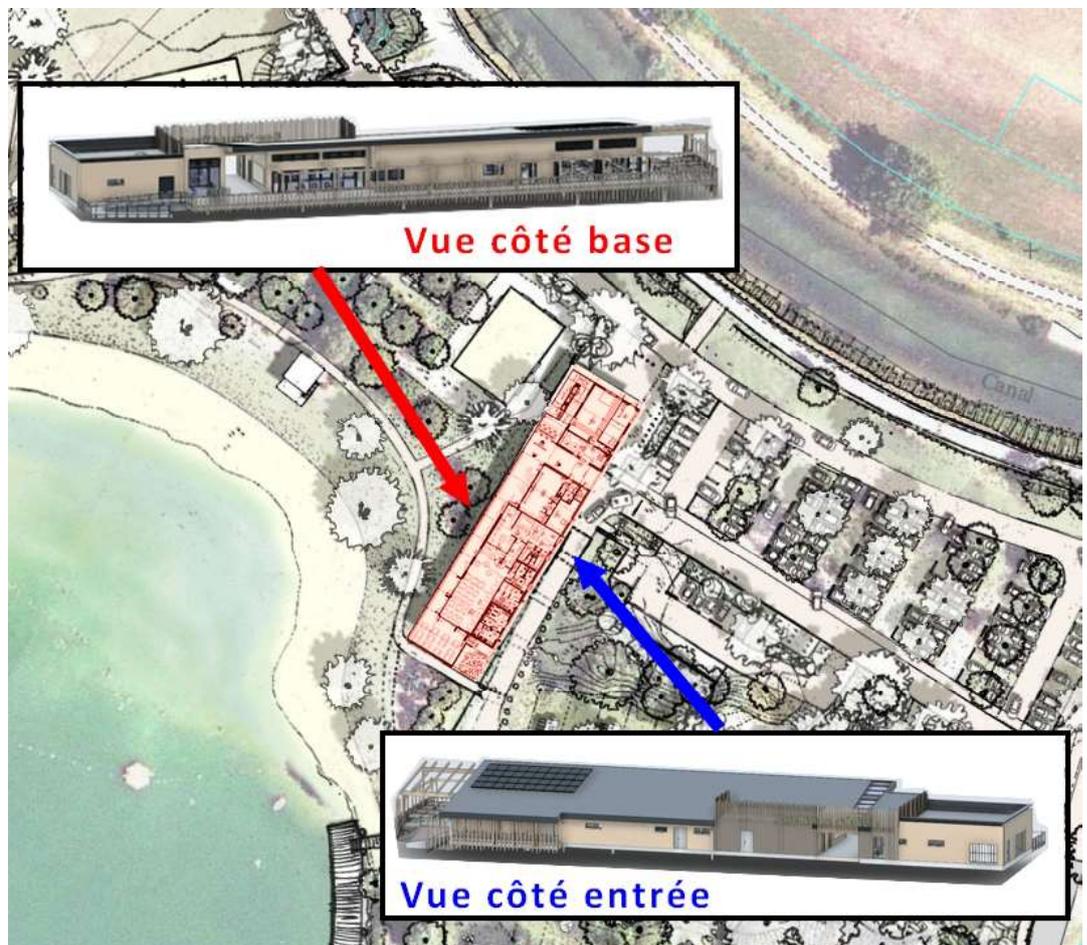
Plan du bâtiment d'accueil multiservices (GBM, 05/2022)
